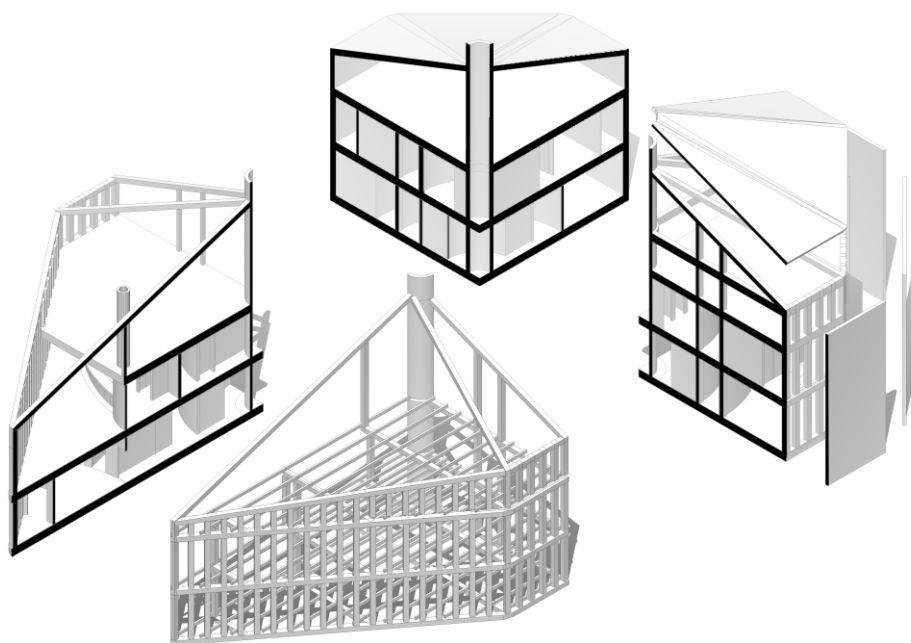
Конструктивная схема соединения частей общественного блока
